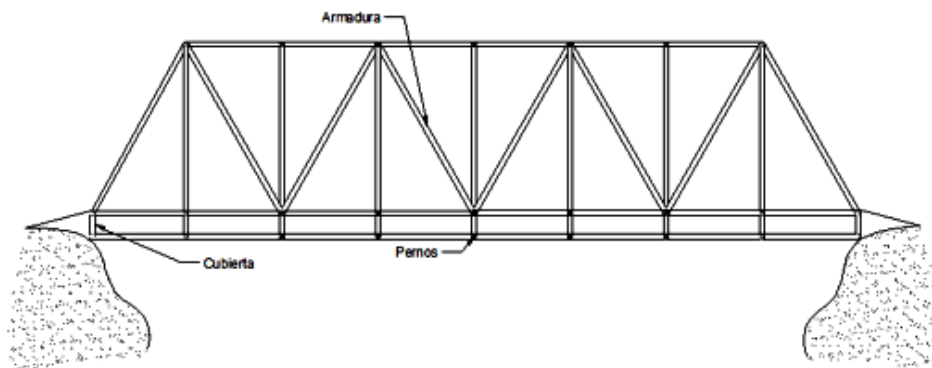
Ejemplo de puente tipo armadura. (Editado en AutoCAD)
